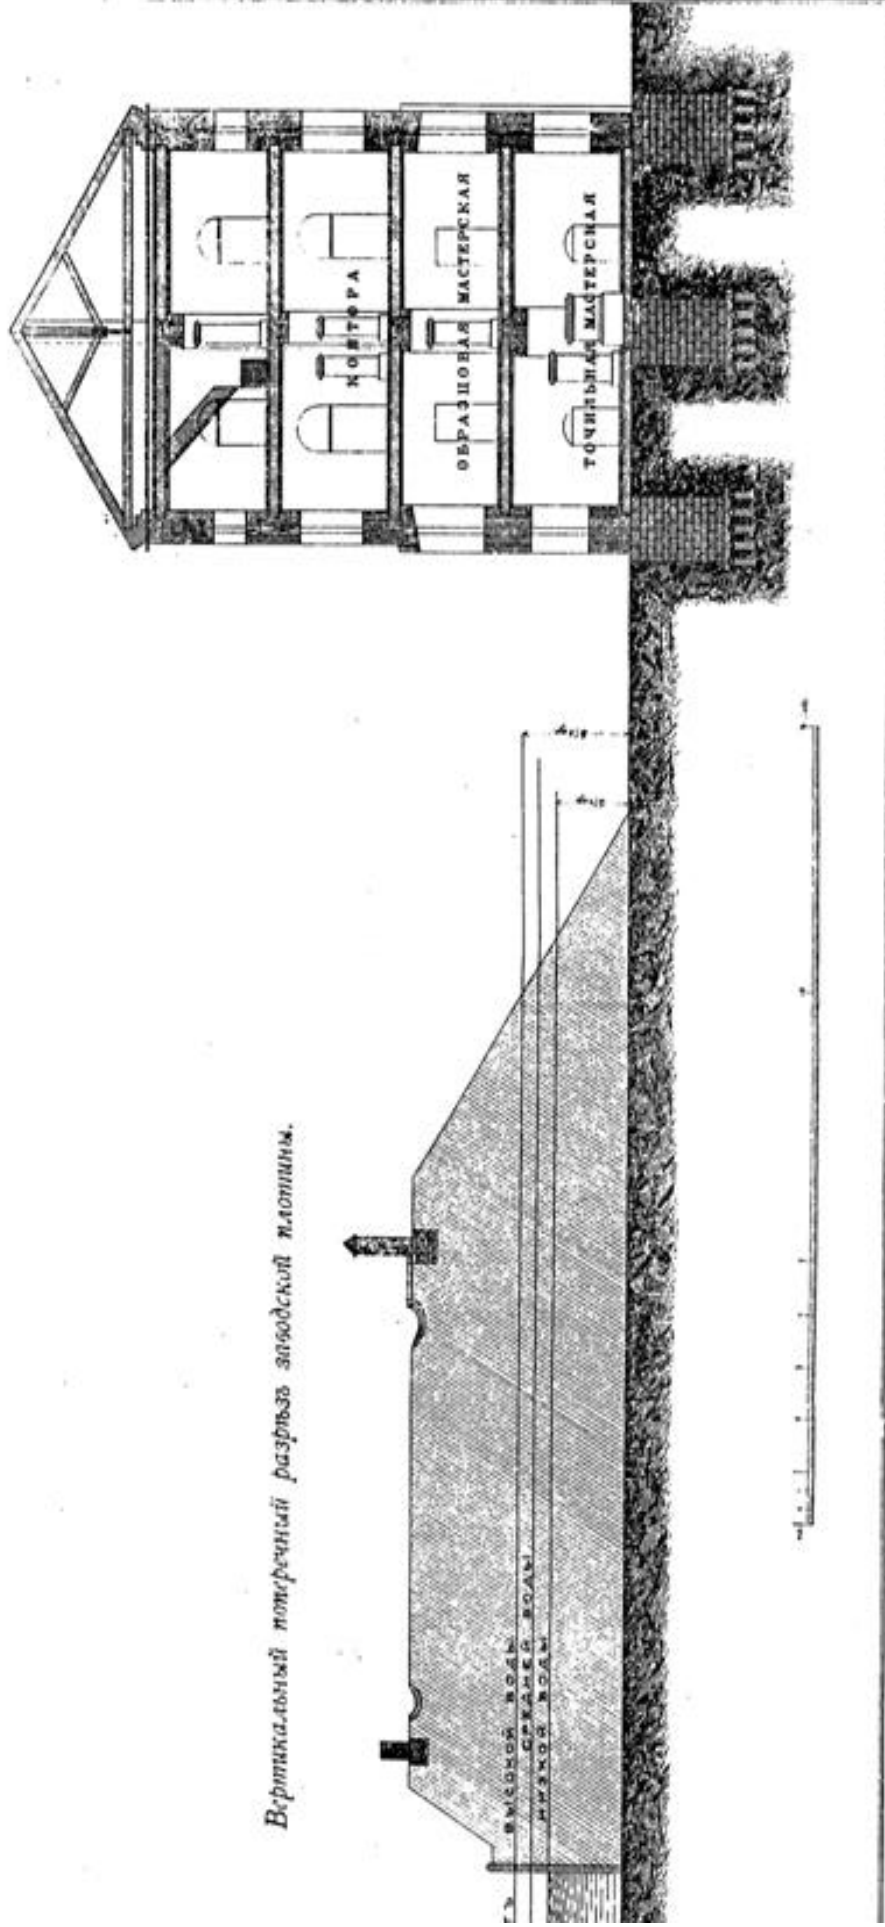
Вертикальный поперечный разрез заводской плотины. Поперечный разрез 4-х этажного корпуса
